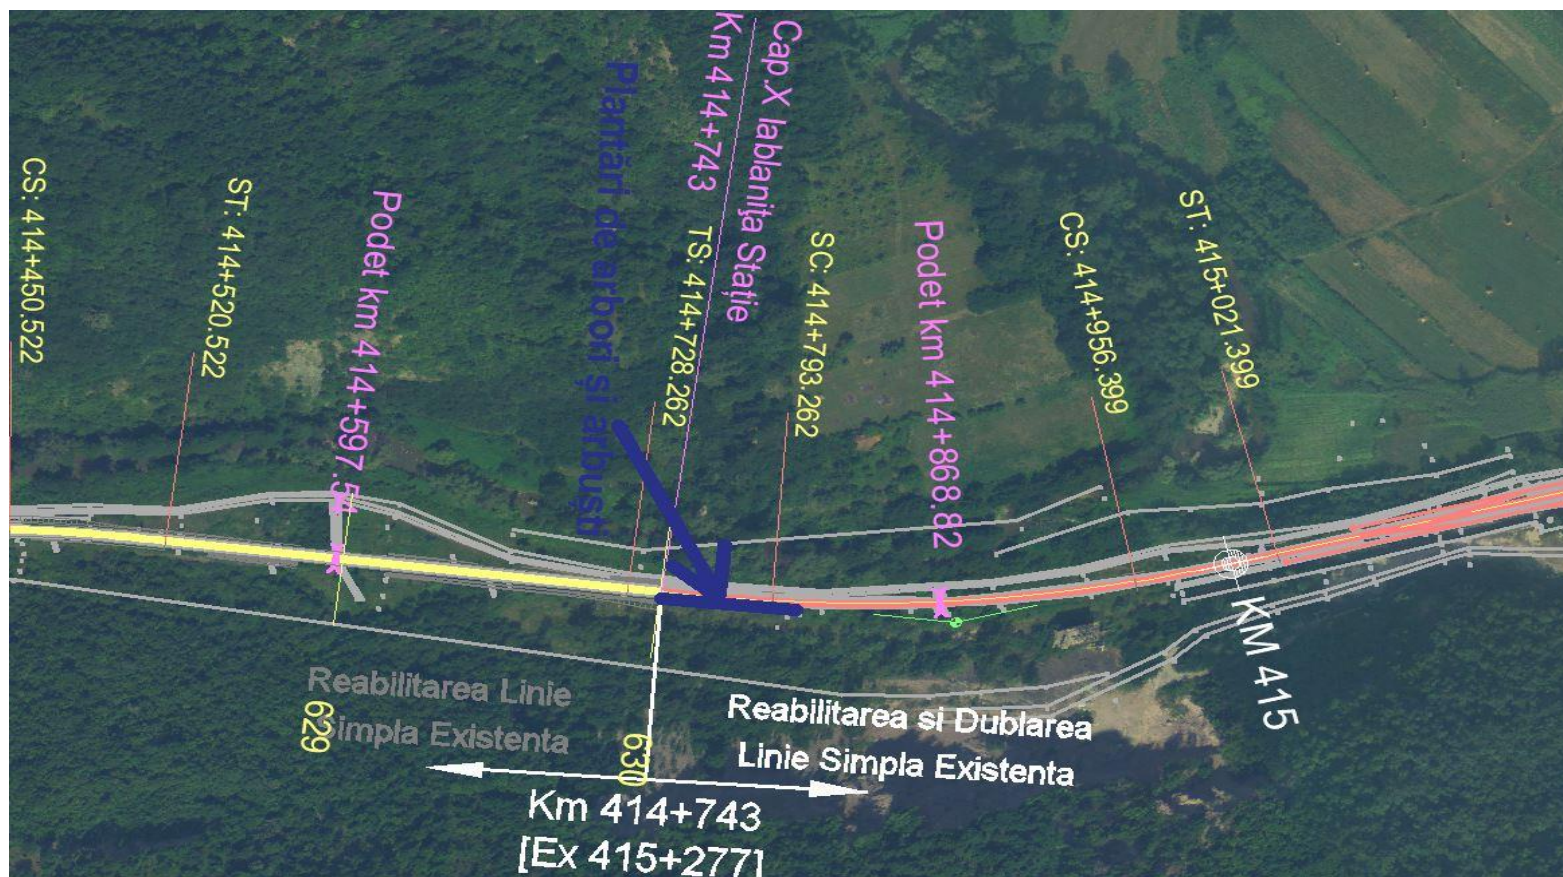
Amplasarea zonei de plantare în zona stației Iablanța km pr. 414+740 – km.pr.414+800
